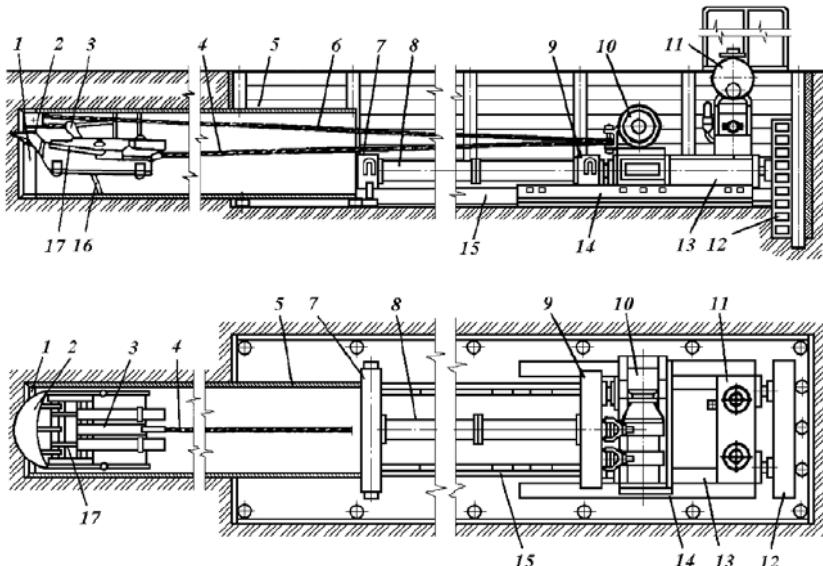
Установка для прокладки труб продавливанием с механизированной разработкой грунта:
